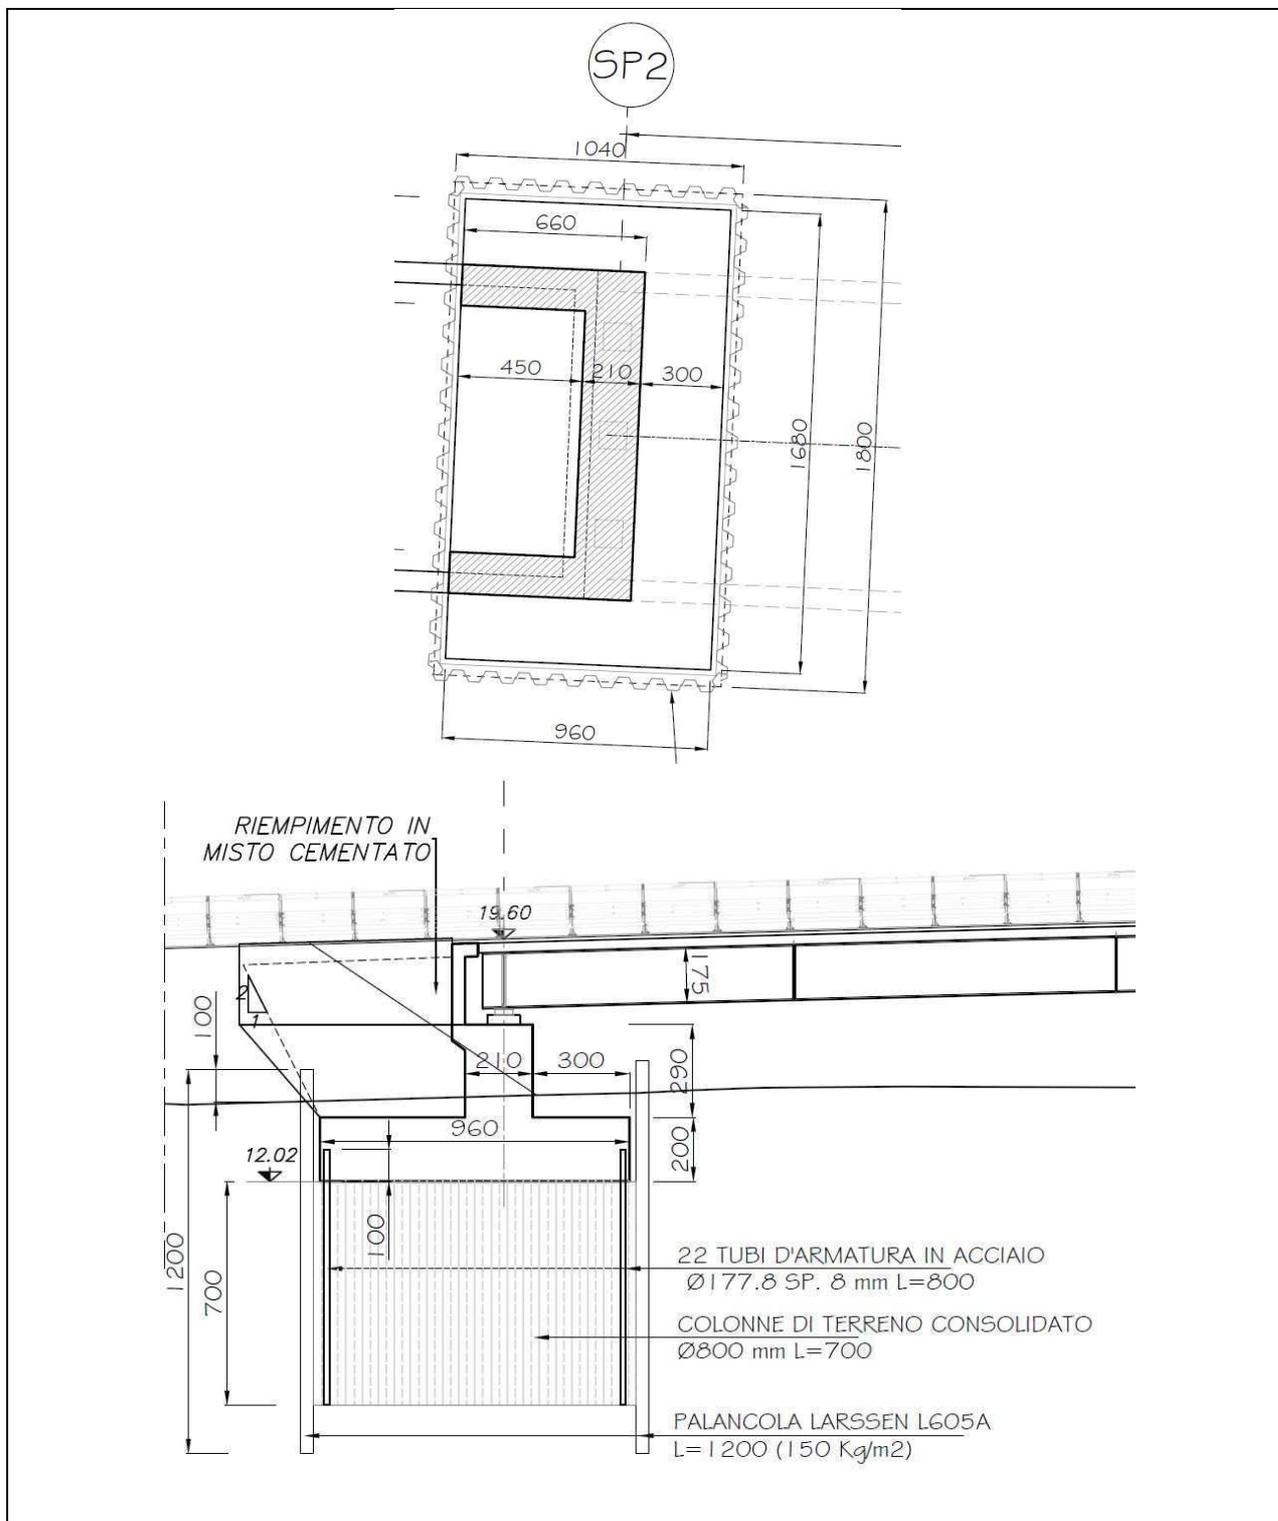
Spalle - Pianta Fondazioni Sezione Fondazioni
